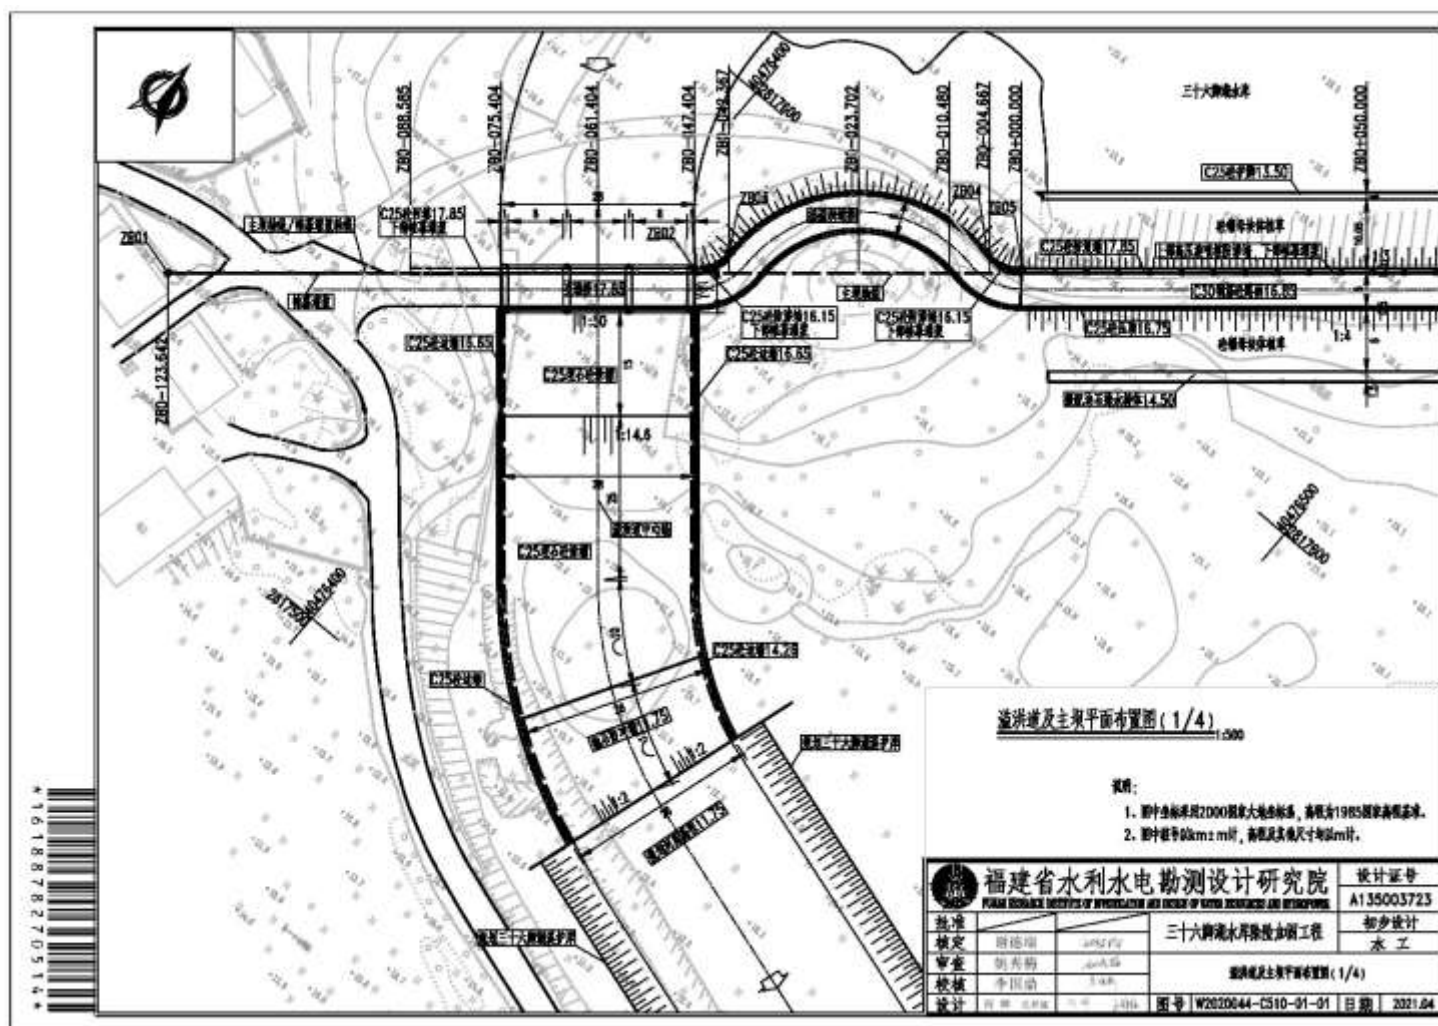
溢洪道及主坝平面布置图 (局部)
